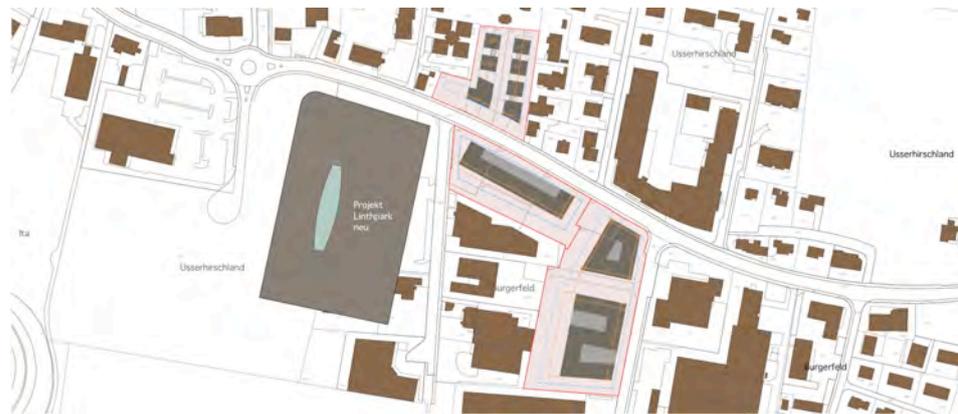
Projektgebiet Uznach West (Detailplan, Anhang 5/6)
